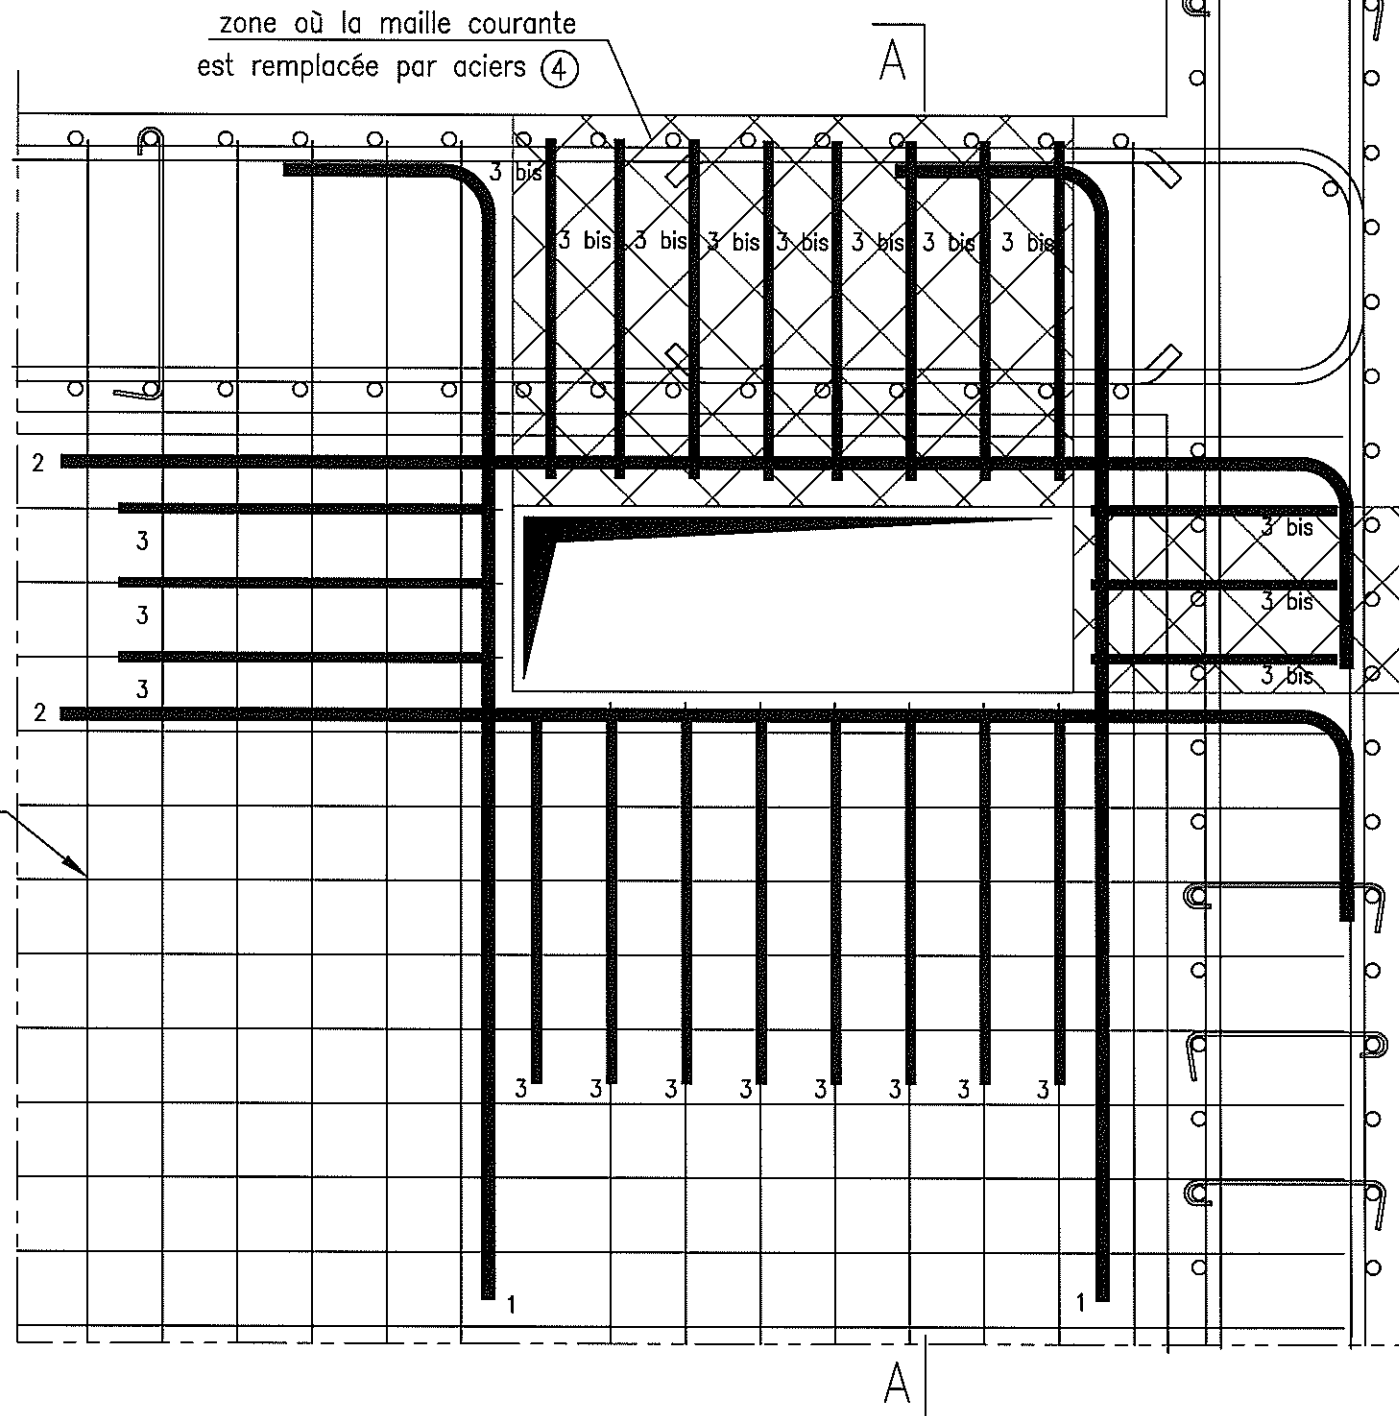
DETAIL D'UNE TREMIE SIMPLE TRES PROCHE D'UN VOILE OU D'UN PLANCHER
